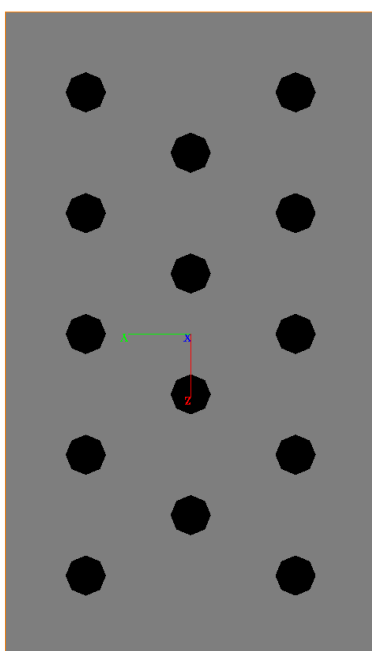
Vista planimetrica del modello GROUPv2016.
